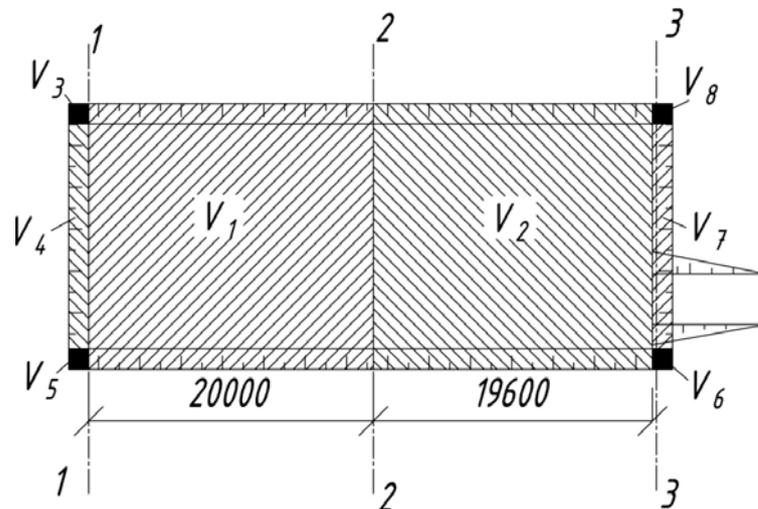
Разбивка котлована на сечения 1—1, 2—2, 3—3
